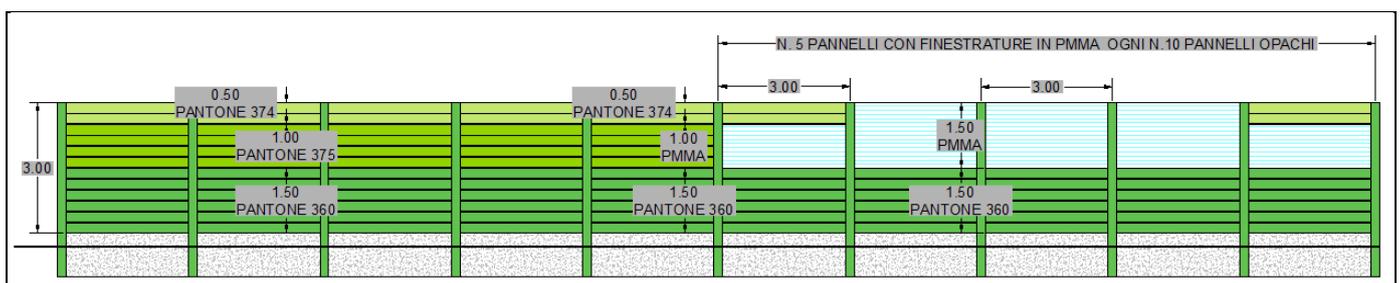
PROSPETTO TIPO BARRIERA ANTIRUMORE H 3,5 M CON PANNELLI IN PMMA DI DIMENSIONI 3X1 E 3X2 M CON ANDAMENTO SCALARE DIVENTANDO A TUTTA ALTEZZA
